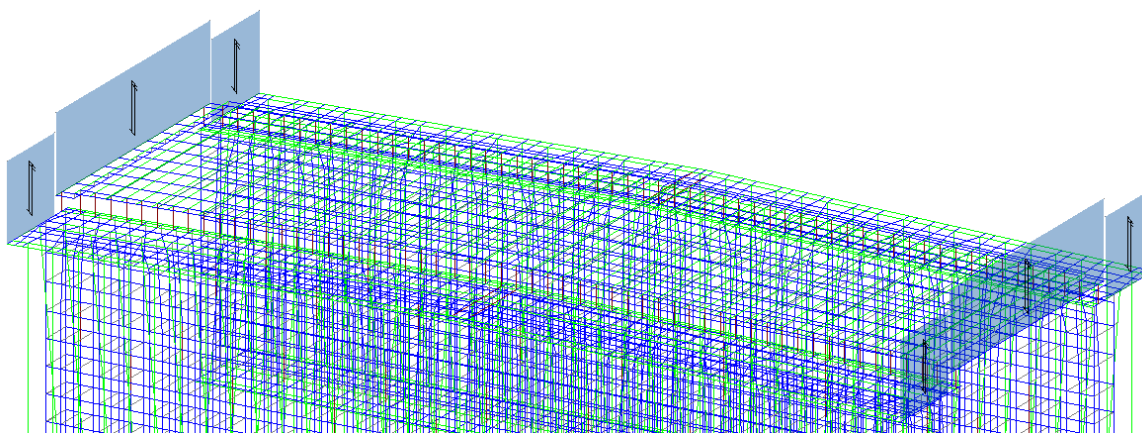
Modello 3D - Particolare elementi solaio per l'attribuzione dell'azione del vento
